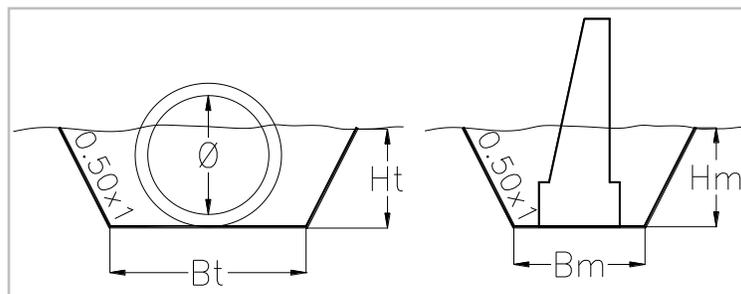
ALTURAS DE EXCAVACIÓN EN TUBOS
